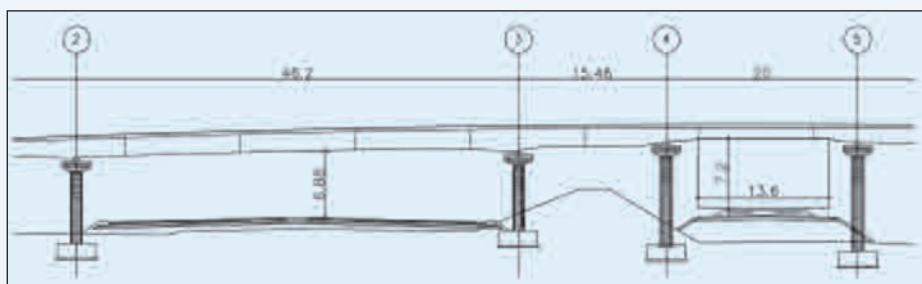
Il prospetto tipo degli attraversamenti della A4
